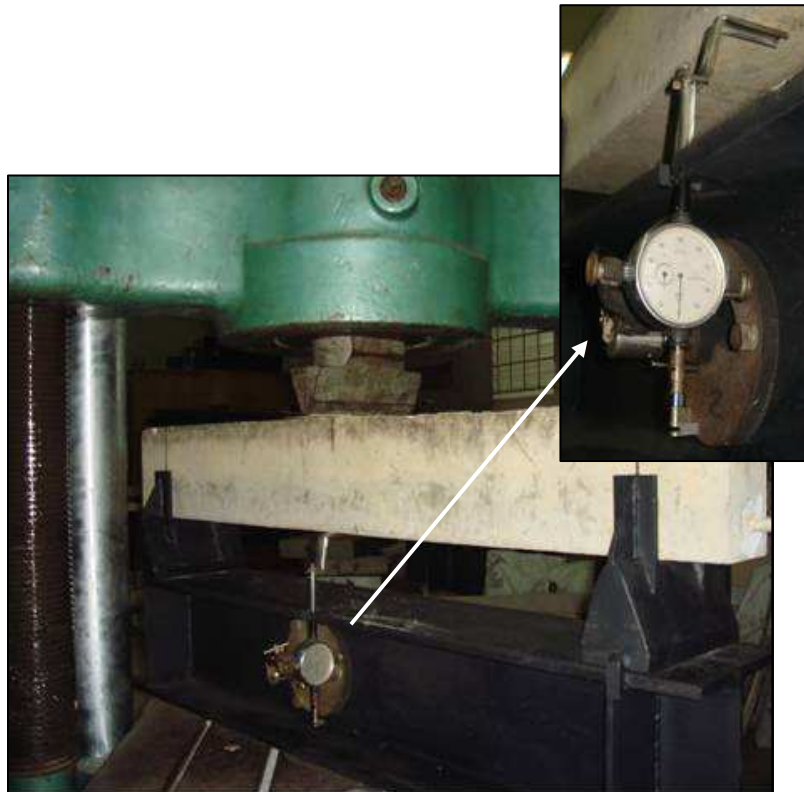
Viga de hormigón instalada en la viga de acero dispuesta para ser sometida a carga. Aumento del flexímetro utilizado
